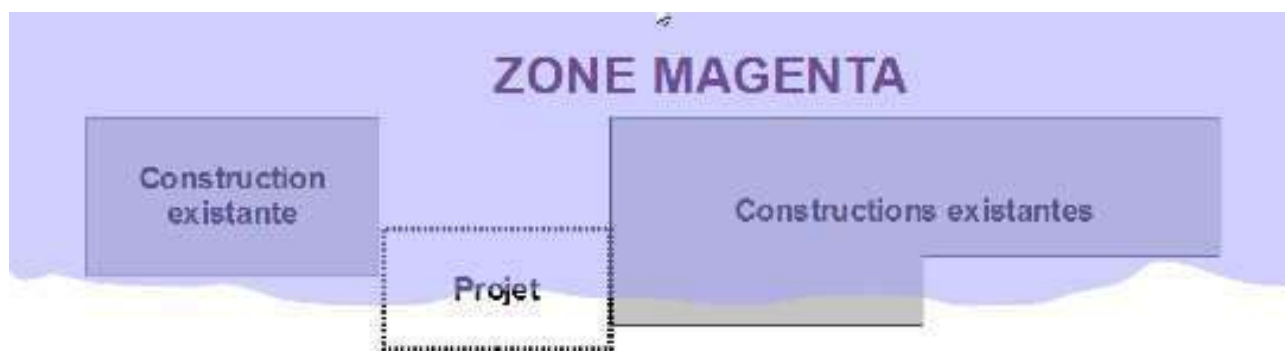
Construction située en dehors de l'alignement : NON ADMIS
